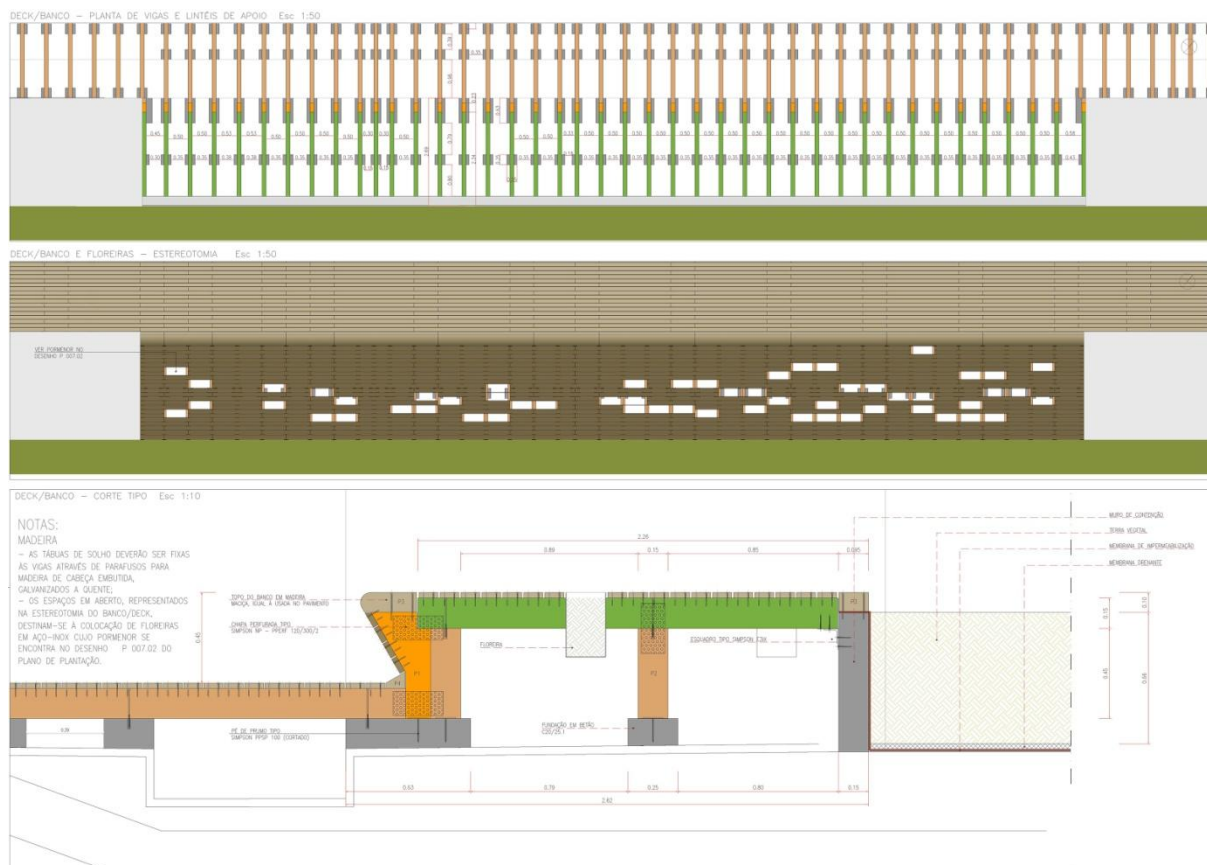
Pormenor construtivo do banco com floreiras em madeira proposto para o limite sudeste
